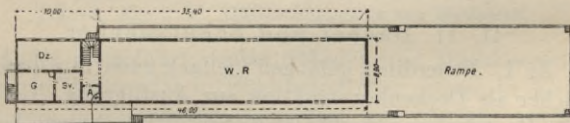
M. = 1:1000. Grundriß eines Güterschuppens.
